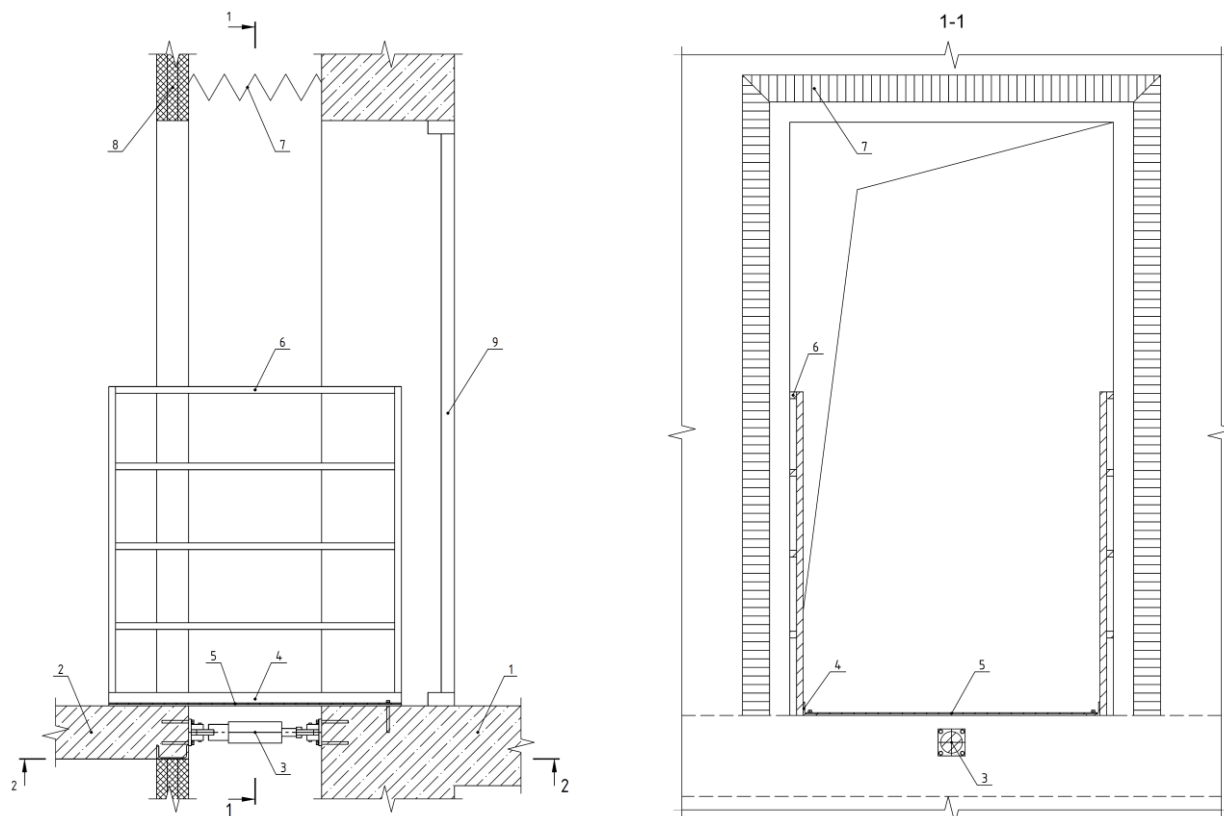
Переход между подвешенной частью здания и несущим стволом: 1 – несущий ствол; 2 – плита перекрытия; 3 – демпфирующее устройство; 4 – уголок; 5 – настил; 6 – ограждение; 7 – гофрированный материал; 8 – стеновая панель; 9 – дверное полотно
